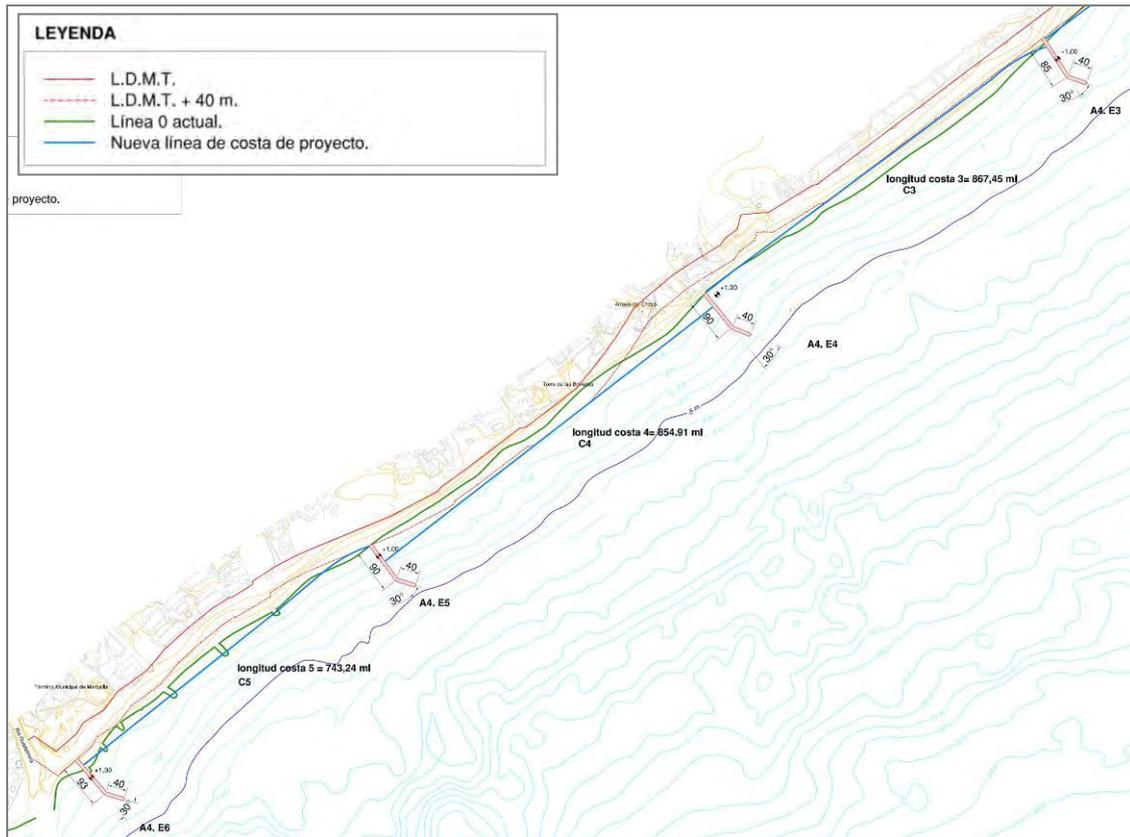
Planta Alternativa 4. Celdas C3-C5.
